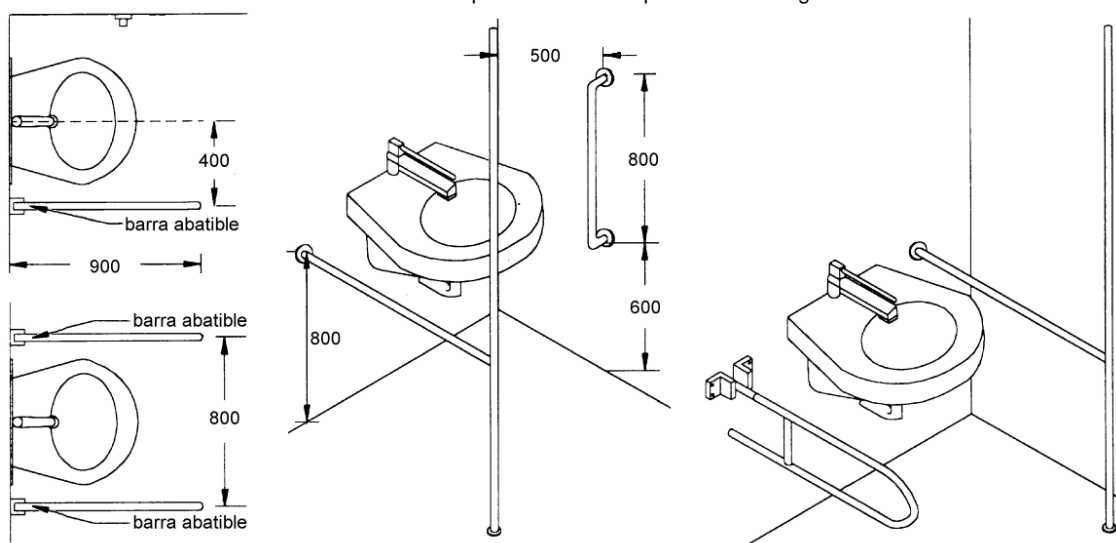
Barras de apoyo. Forma y disposición. Lavado
